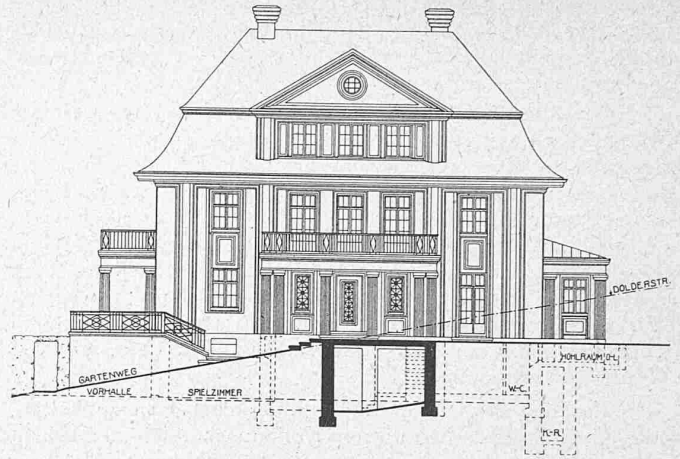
bis 7. Grundrisse zum Hause Dolderstrasse Nr. 71. — Masstab 1:300. — Abb. 3 (oben). Eingangs-Front an der Dolderstrasse.
